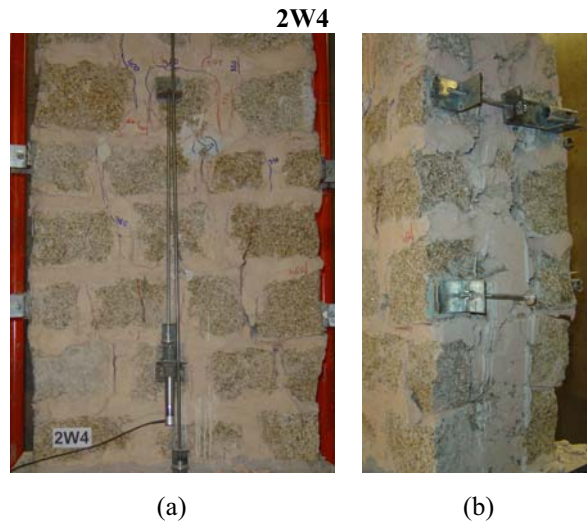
Padrão de fendilhação da parede 2W4 no final do ensaio: (a) face B; (b) face C.
